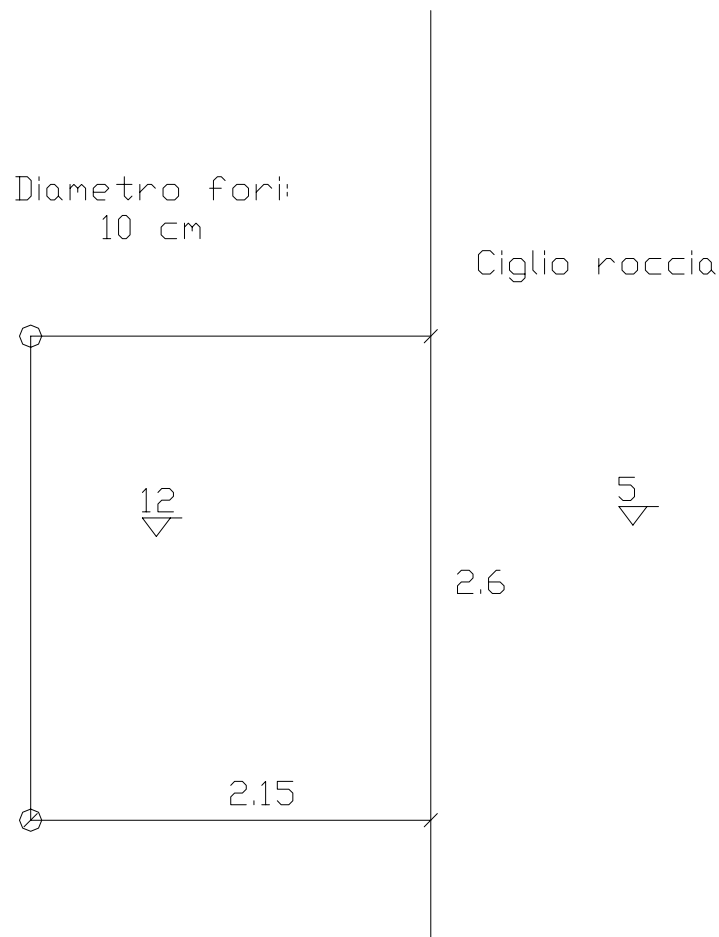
Pianta della disposizione dei fori per il brillamento del volume elementare
